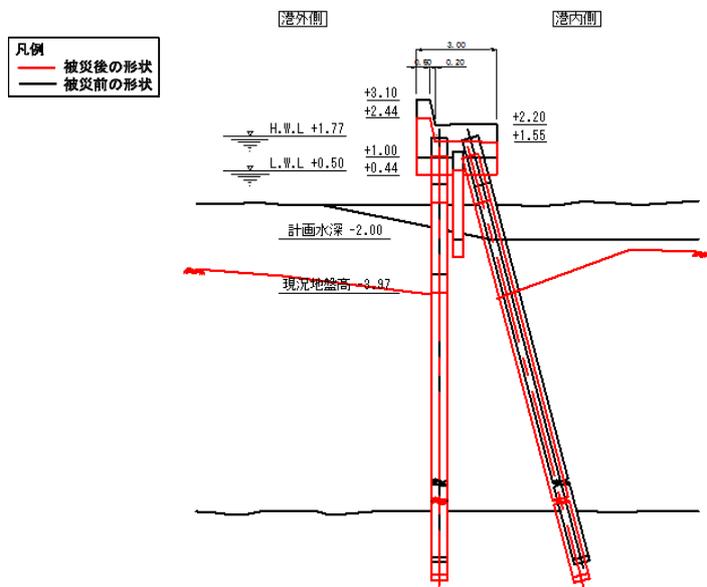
塩釜港区\_東宮浜東防波堤の断面図（被災後）
